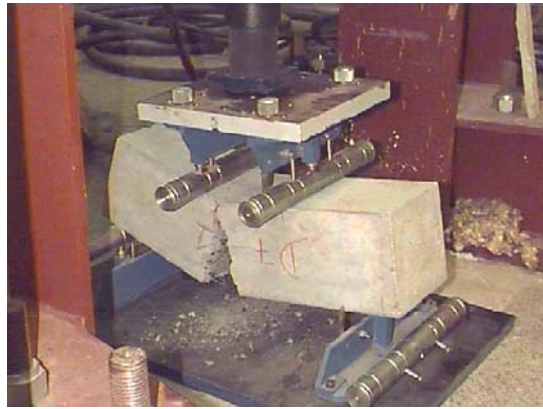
Ensaio de resistência de uma viga à tração na flexão.
